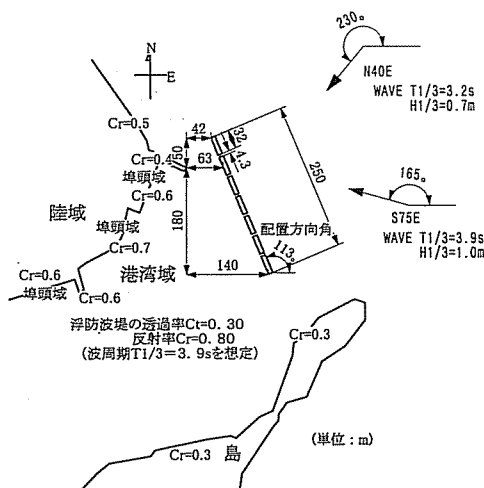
韓国 W 港の平面形状と浮防波堤の配置状況 (CASE 5, 浮防波堤 1 基の長さ 32 m, 開口長 4.3 m, 設置長 250 m)
